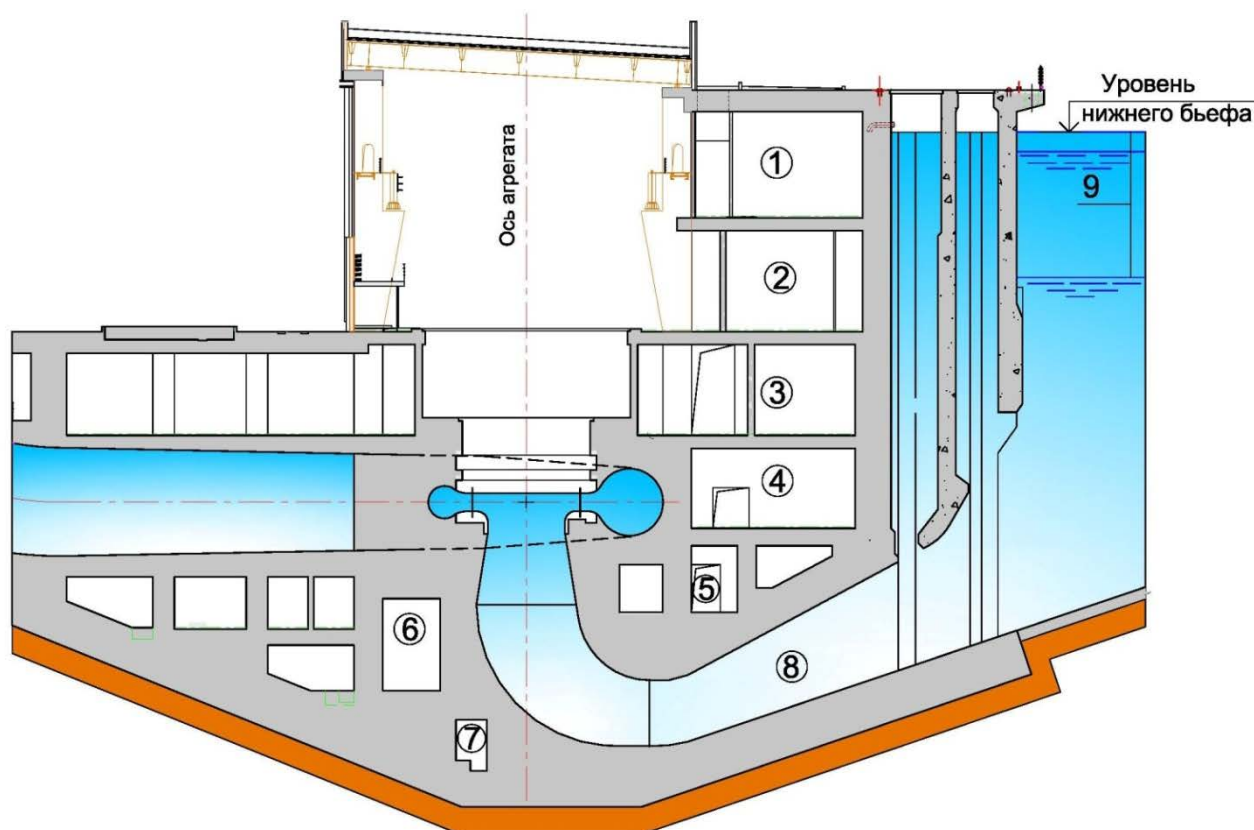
Разрез по оси водопроводного тракта здания ГАЭС (схема):
